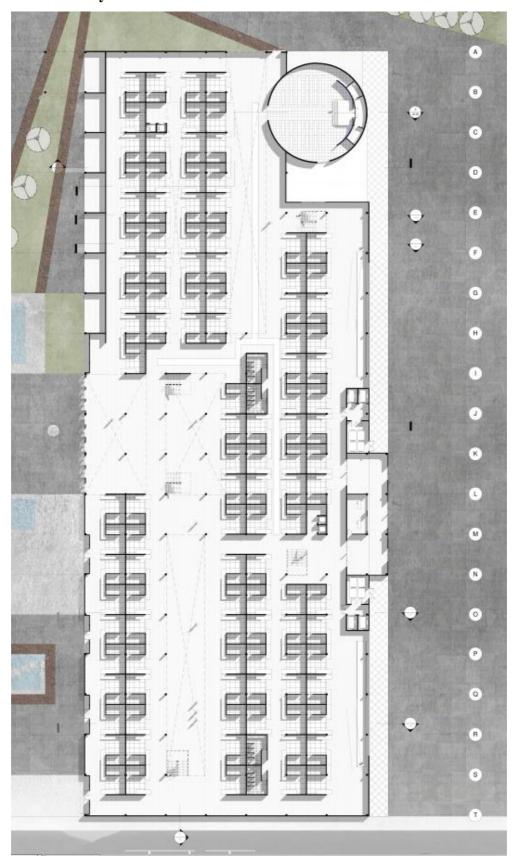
Planta baja mercado Mayorista. Elaboración propia
